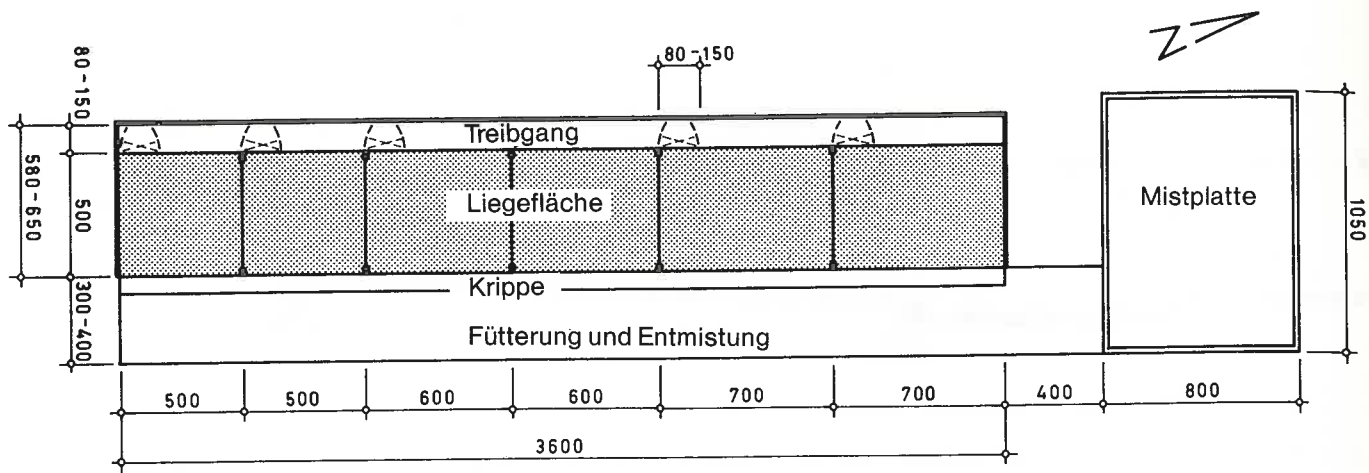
Grundriss des «Elsässer»-Stalles mit sechs Buchten. Ein- und Austrieb der Tiere geschieht über den Treibgang.
